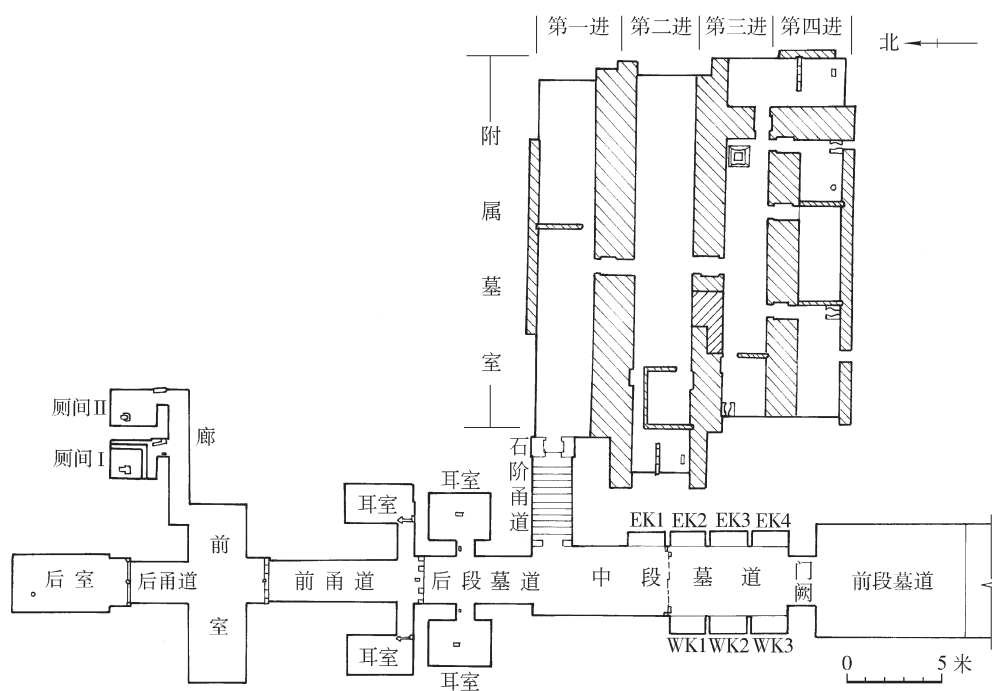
山东省曲阜九龍山 3 号墓平面图 (1/400)
